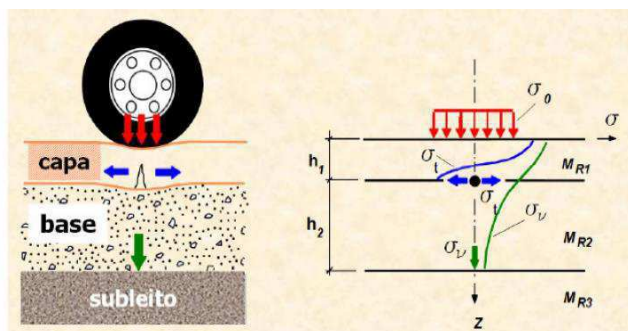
Tensões distribuídas pela estrutura de um pavimento (Medina e Motta,2005)
